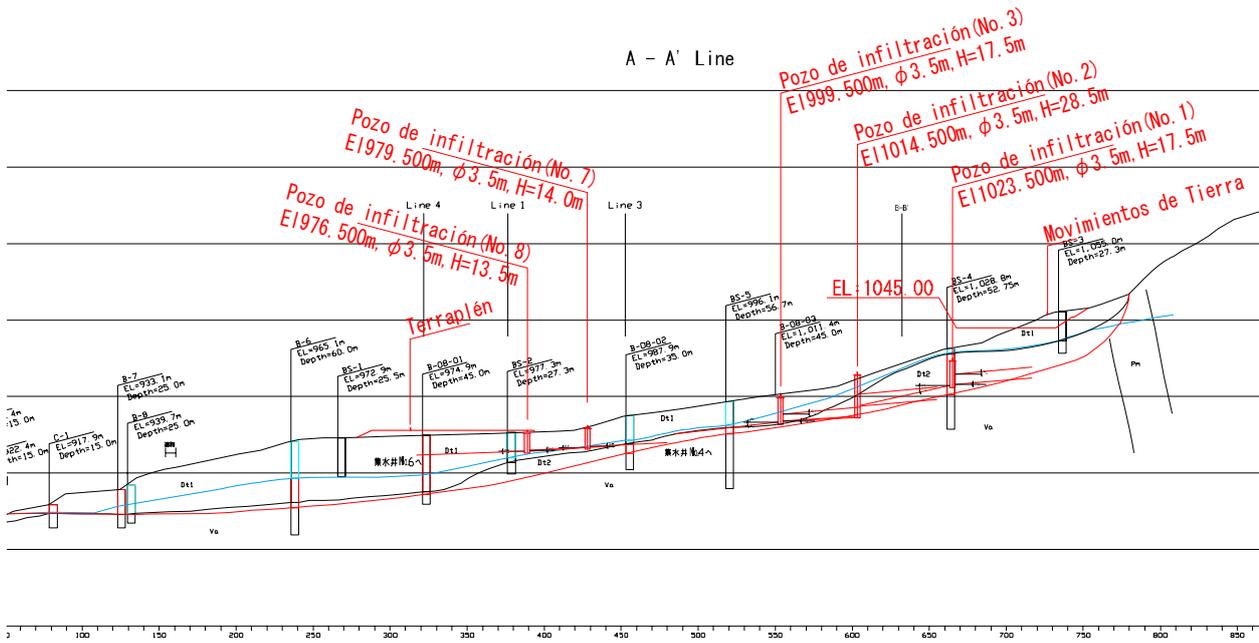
Sección de disposición de los pozos de infiltración (El Berrinche)
